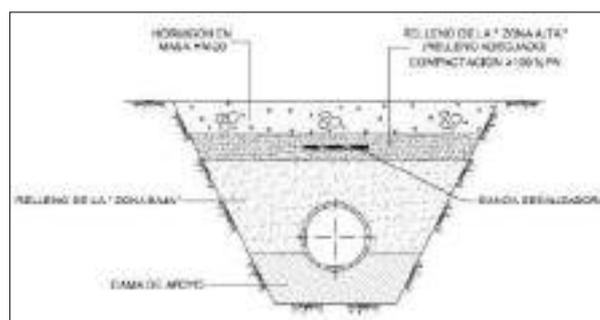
Sección tipo de zanja para tubería de fundición dúctil bajo viarios
